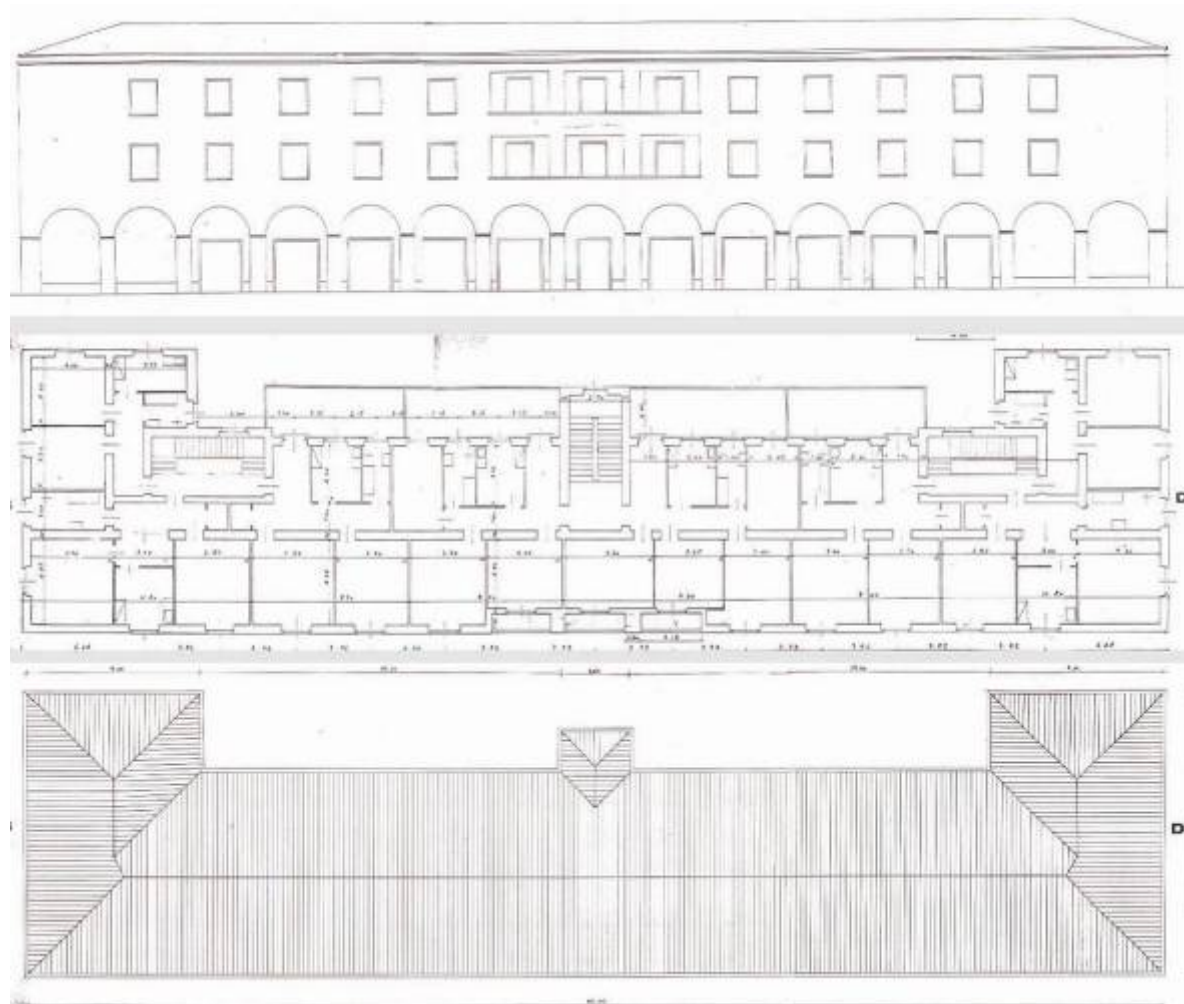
Case I.N.C.I.S. – Prospetto e pianta Piano Primo e Coperture palazzina Nord-Ovest (e simmetrica Nord-Est) rispetto alla via Pola.
